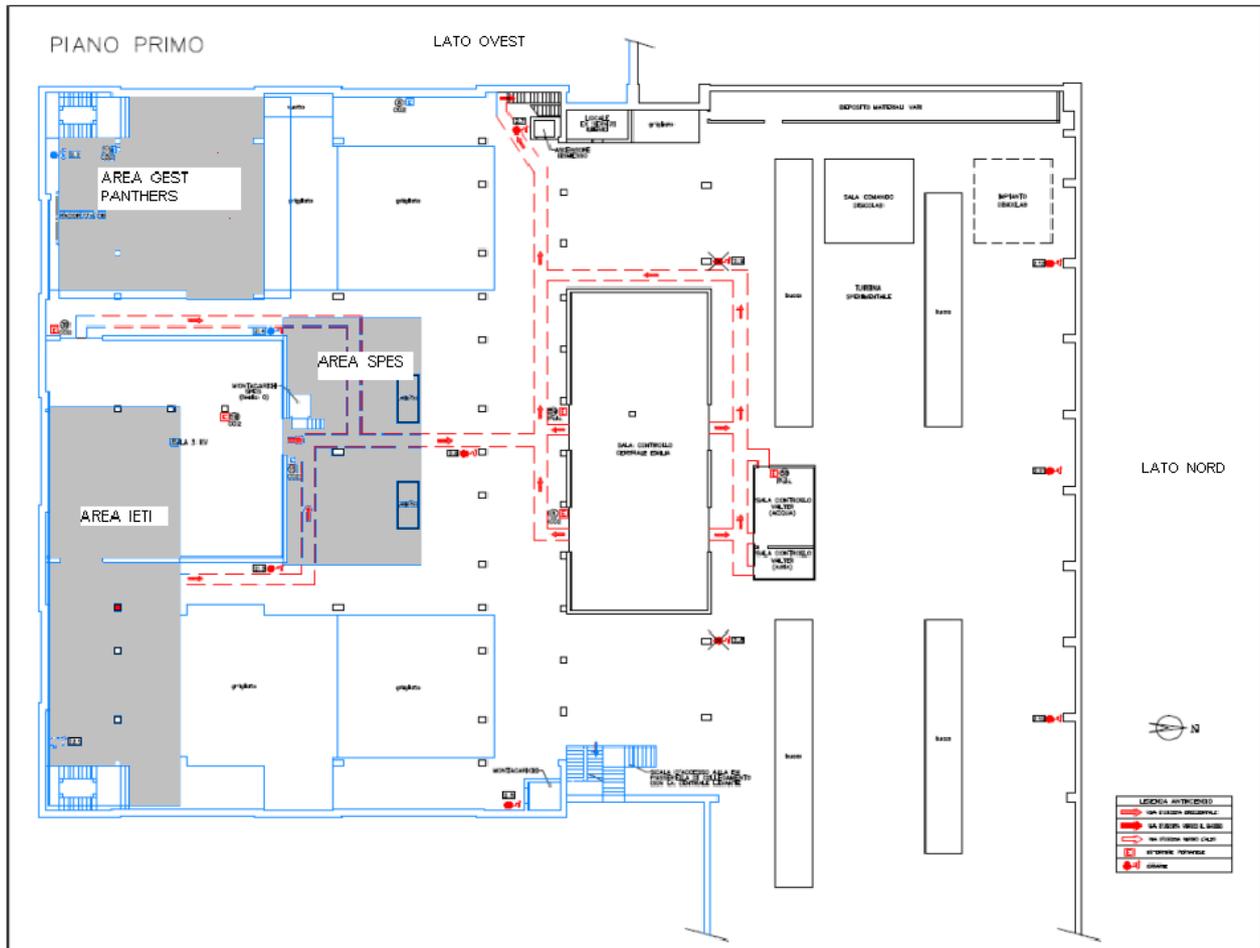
Centrale Emilia - Planimetria 1° piano
